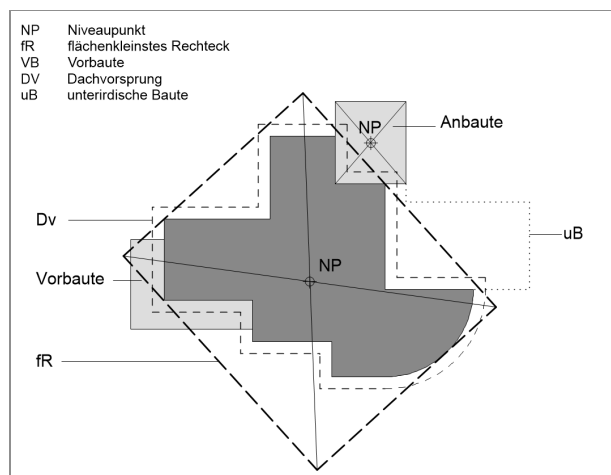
Flächenkleinstes Rechteck für Niveaupunkt über massgebendem Terrain
